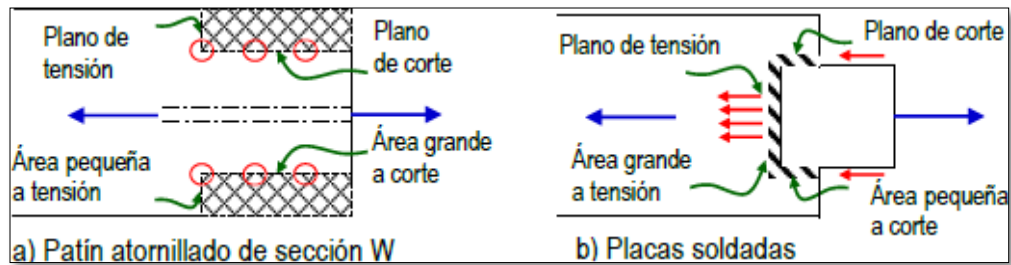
Bloques de cortante en conexiones atornilladas y soldadas.
